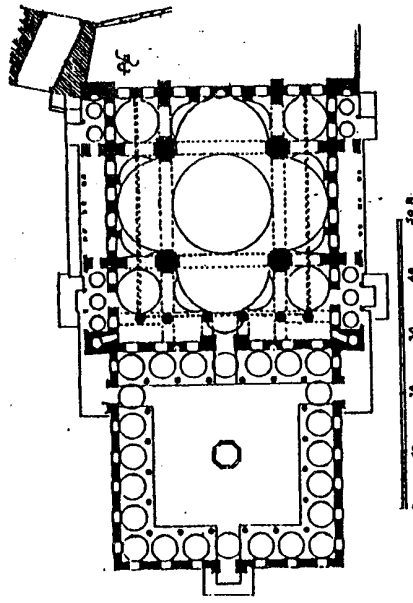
مسقط أفقي لجامع فاتح باشا بديار بكر
